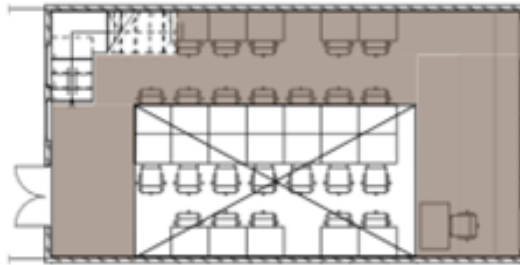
Ruang mezanin terbuka di ruang 4.13, Gedung Muh. Natsir UII
